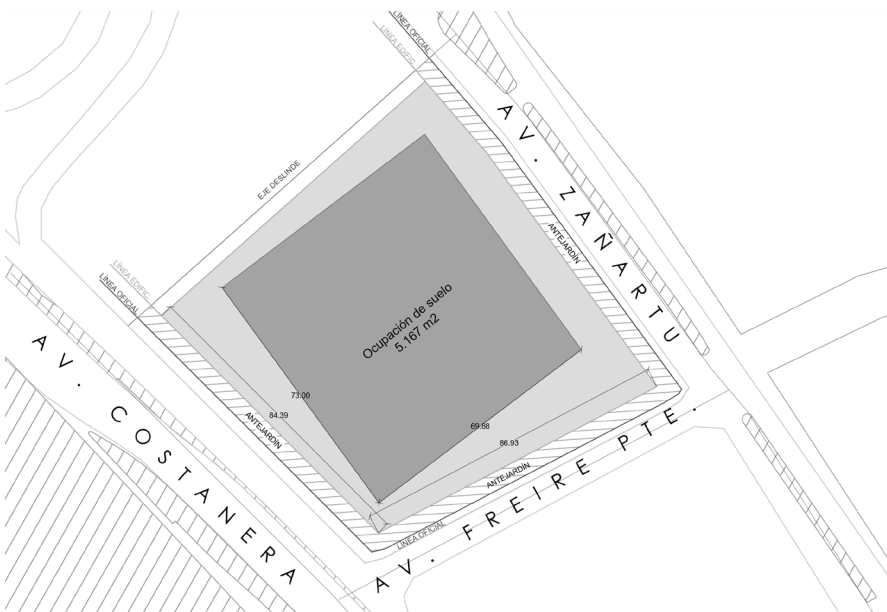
Planta de estudio de cabida Fuente: Elaboración propia.(2023)
